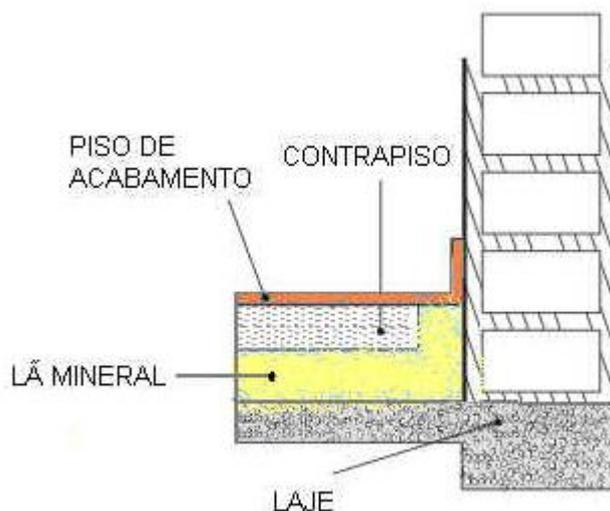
ESQUEMA AMORTECIMENTO DE RUÍDOS ENTRE LAJES
